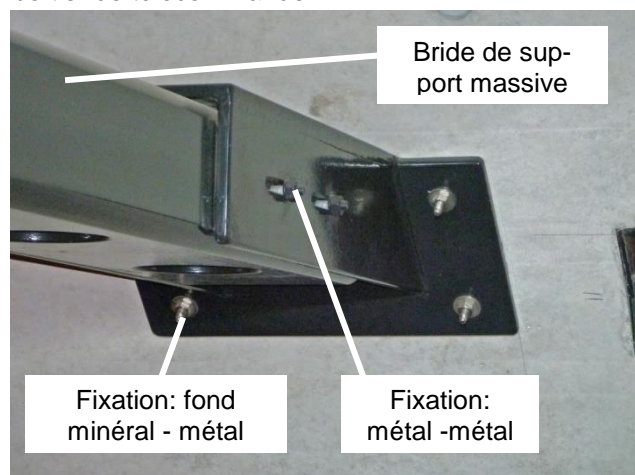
traverse de signalisation à l'intérieur d'un tunnel: détails du montage sur paroi
